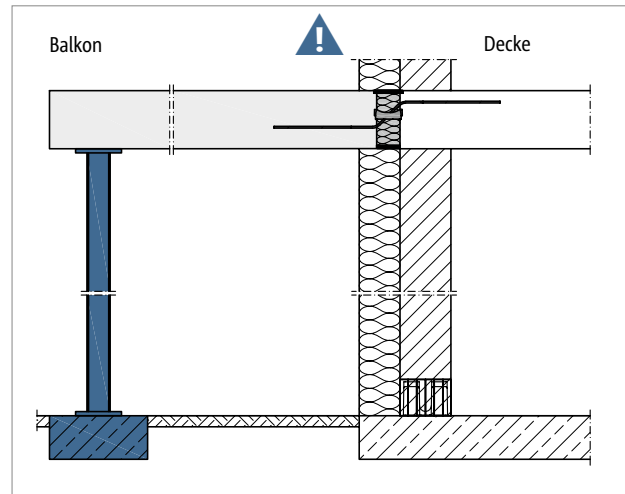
Schöck Isokorb® T Typ Q-ID: Stützung durchgängig erforderlich
